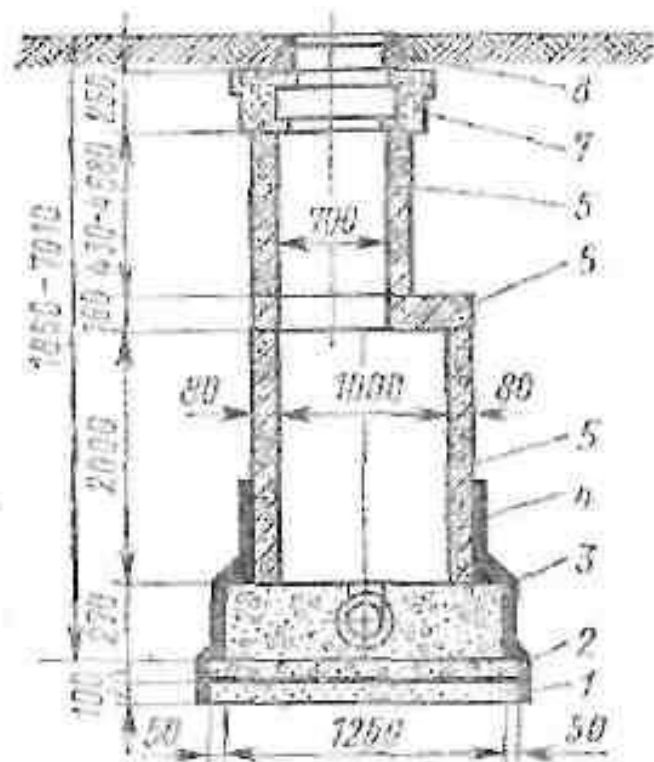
Смотровой колодец из сборных железобетонных элементов;
